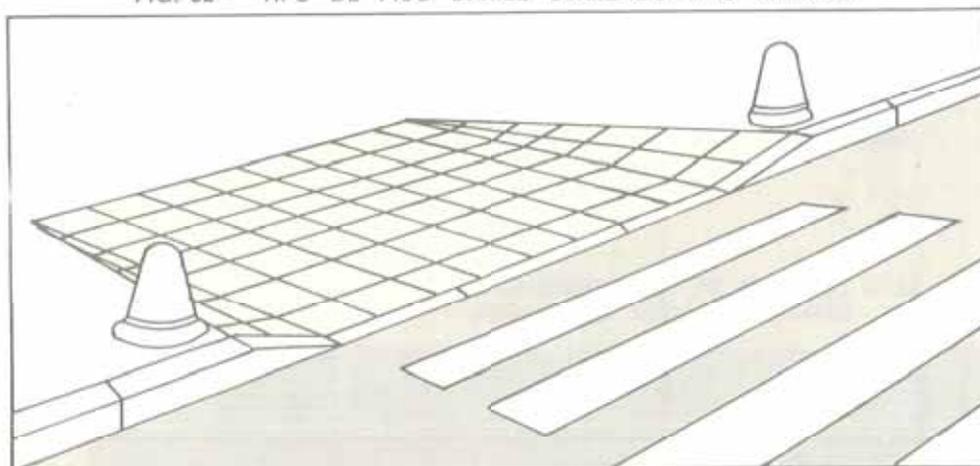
A — PISO BRAILE — DETALHE DA COLOCAÇÃO
